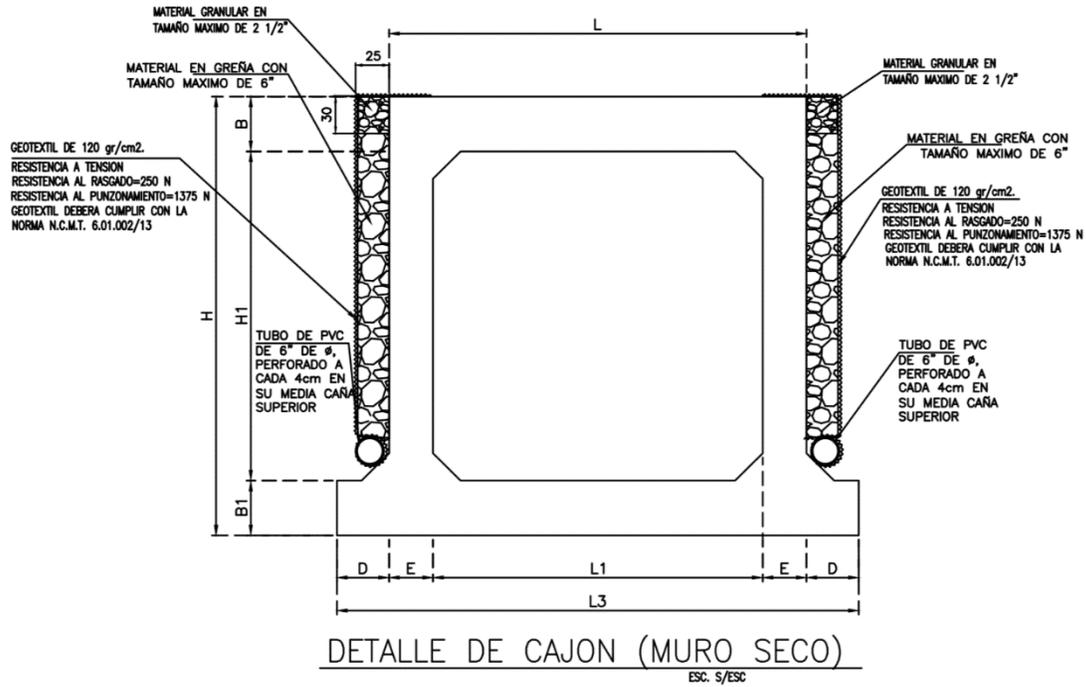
Detalle de protección a cajones PSV's con muro seco y polietileno bi-extruido.
